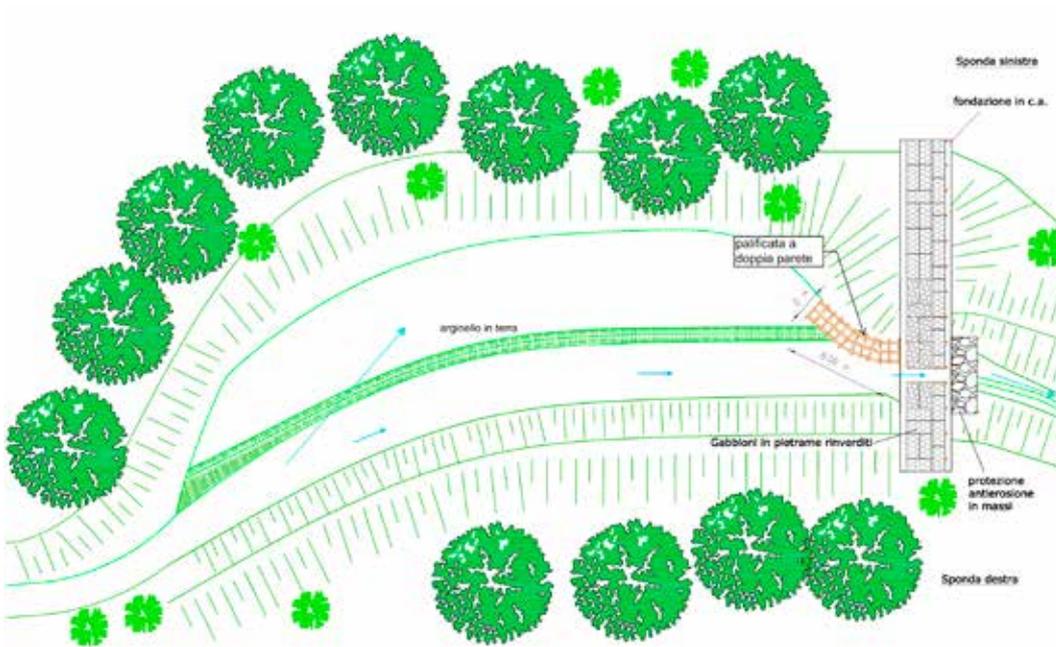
Planimetri di intervento (esempio tratto dal progetto realizzato sul Rio Bianello)
